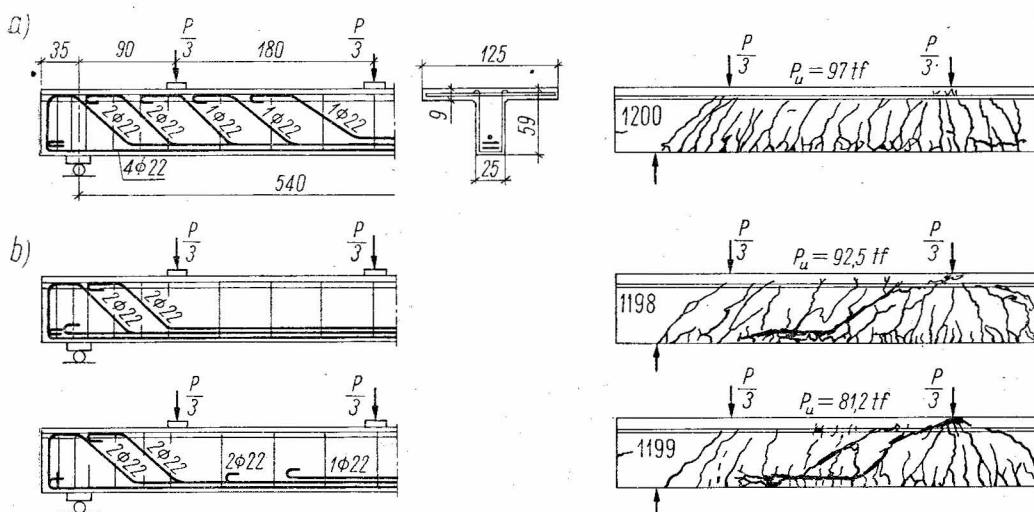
Poutres dans les essais de DAfE, cahier 67 (série I), [30] : a) poutre No 1200 avec le cisaillement entièrement transmis par l'armature, b) poutres Nos 1198 et 1199 avec l'armature transversale conformément à DIN de 1916
